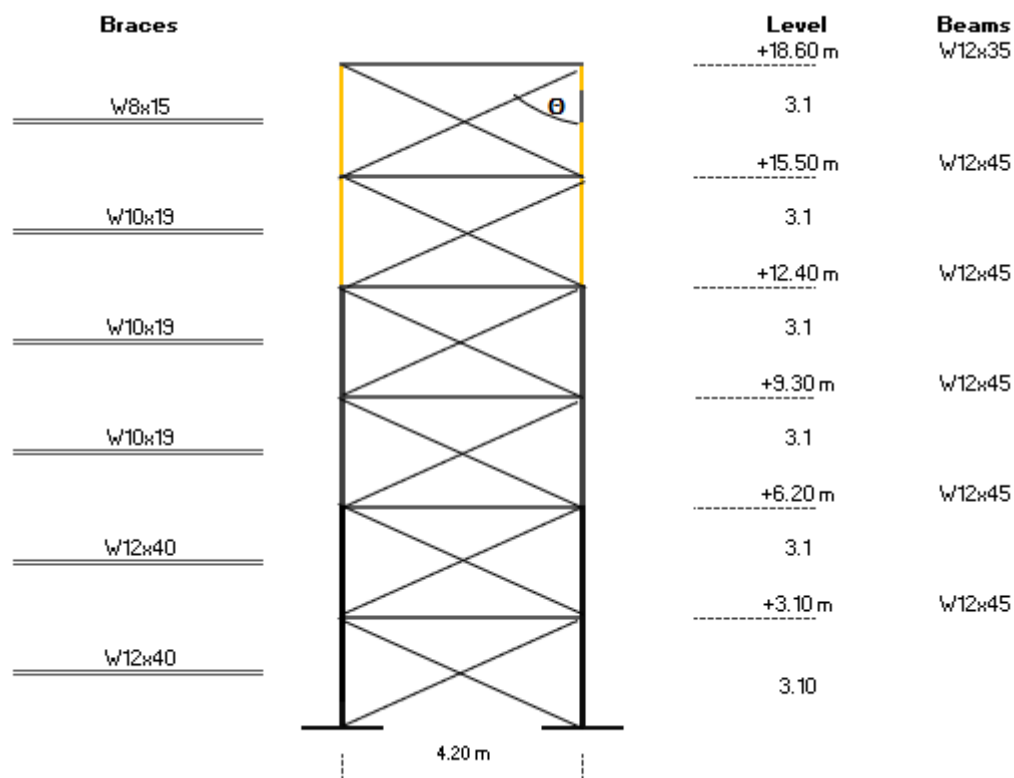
Configuración de vigas y arriostramientos en SENTIDO X
